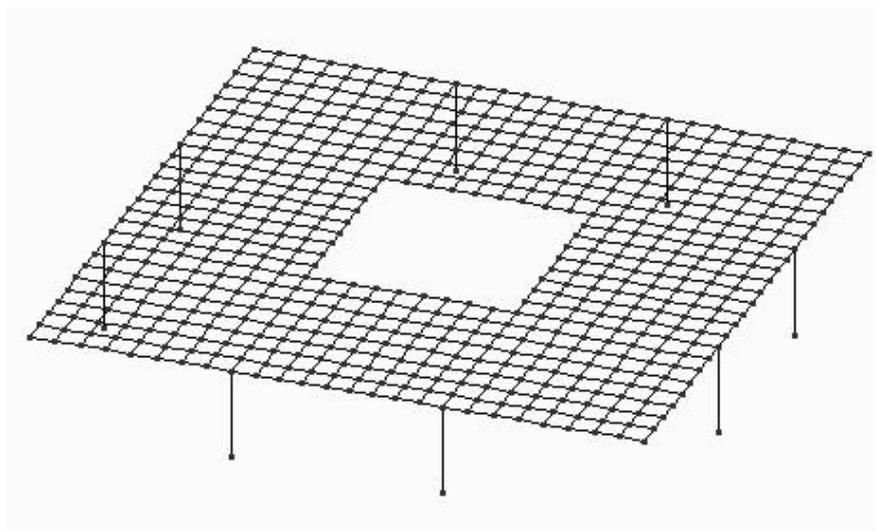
Modelo correspondiente a una planta de los edificios anexos.
